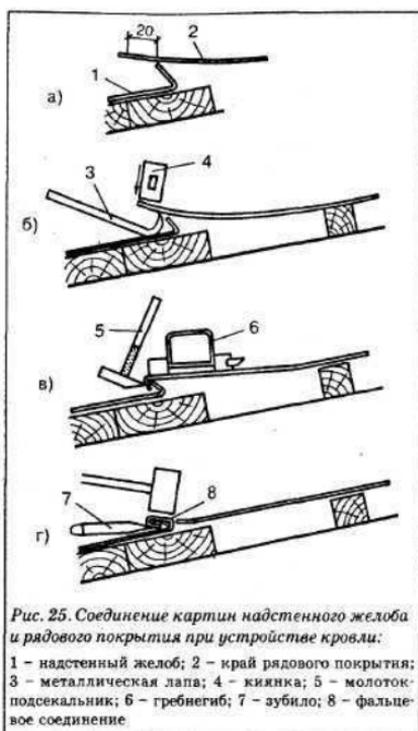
Соединение картин надстенного желоба и рядового покрытия при устройстве кровли:
